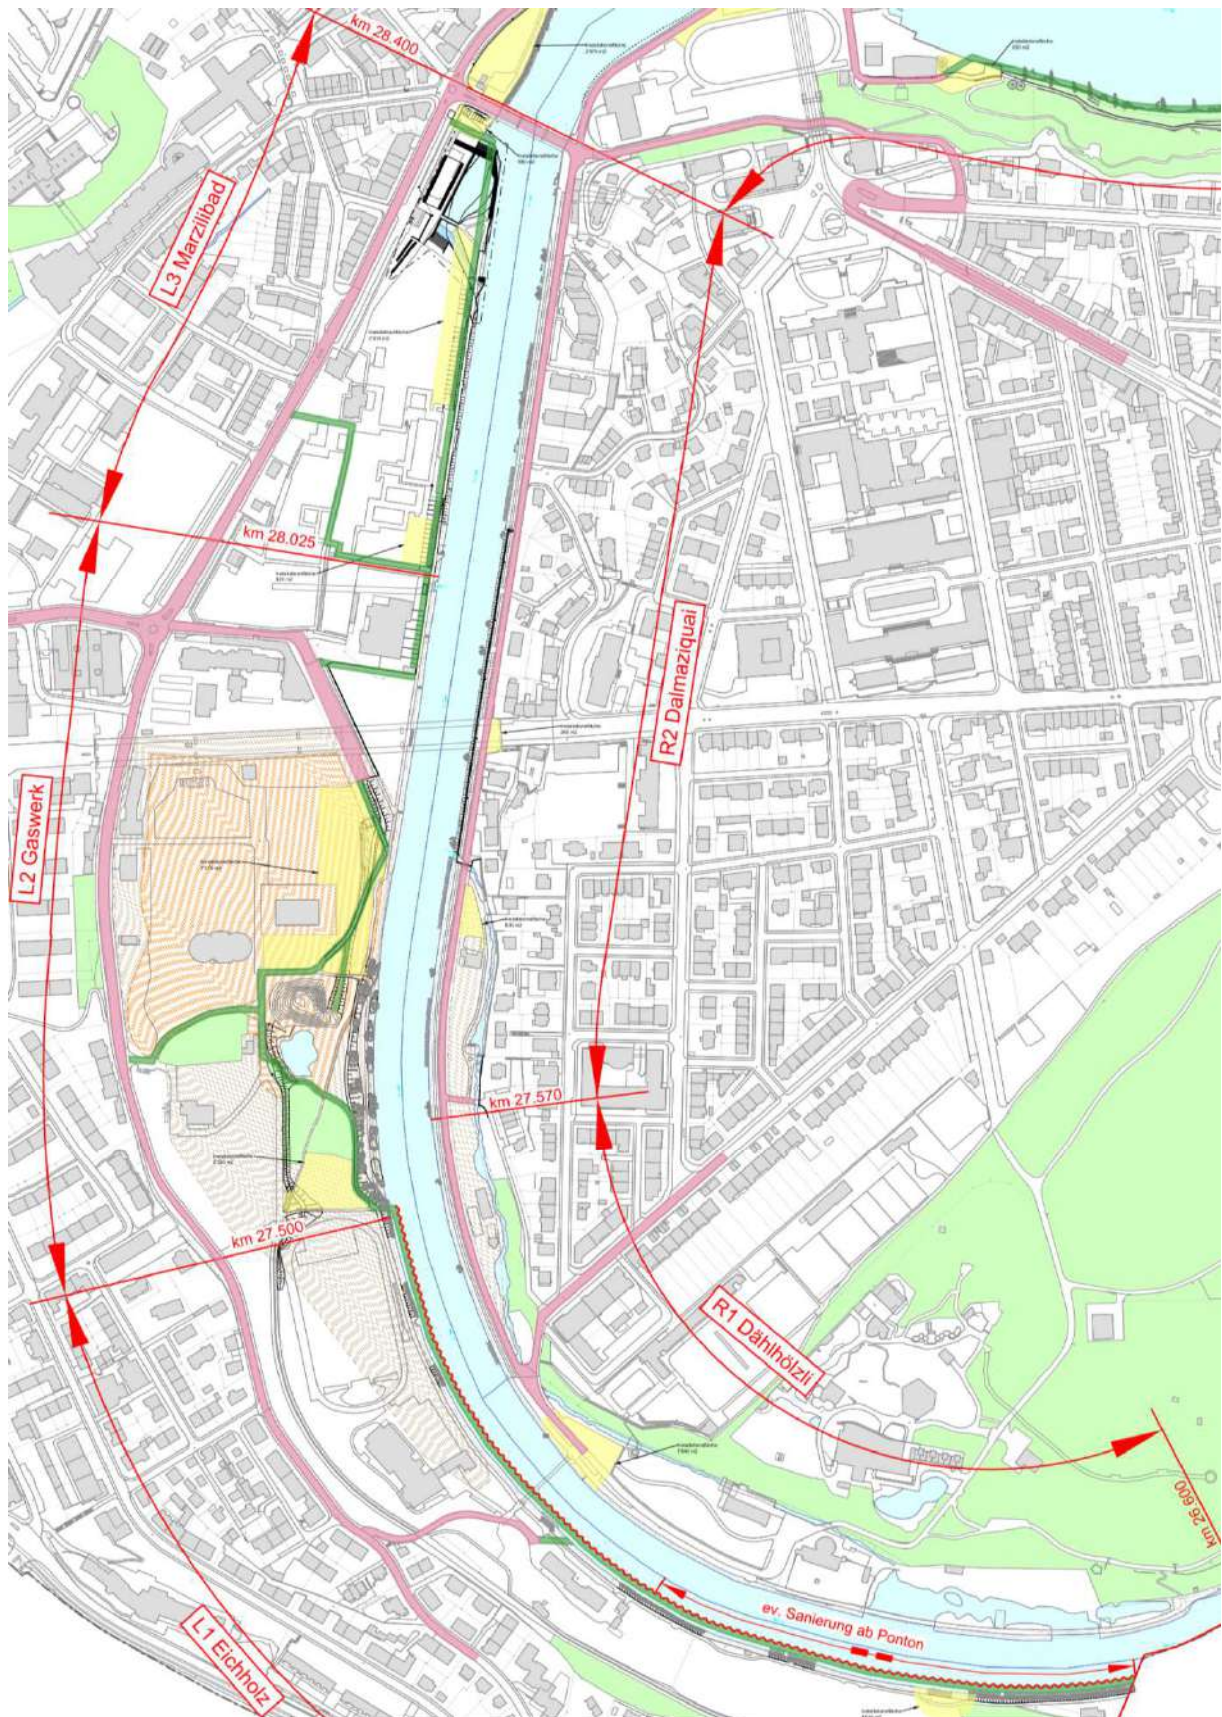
Baustellenerschließung, Baupisten und Installationsplätze, südlicher Teil [1], Wasserbauplandossier [1]
